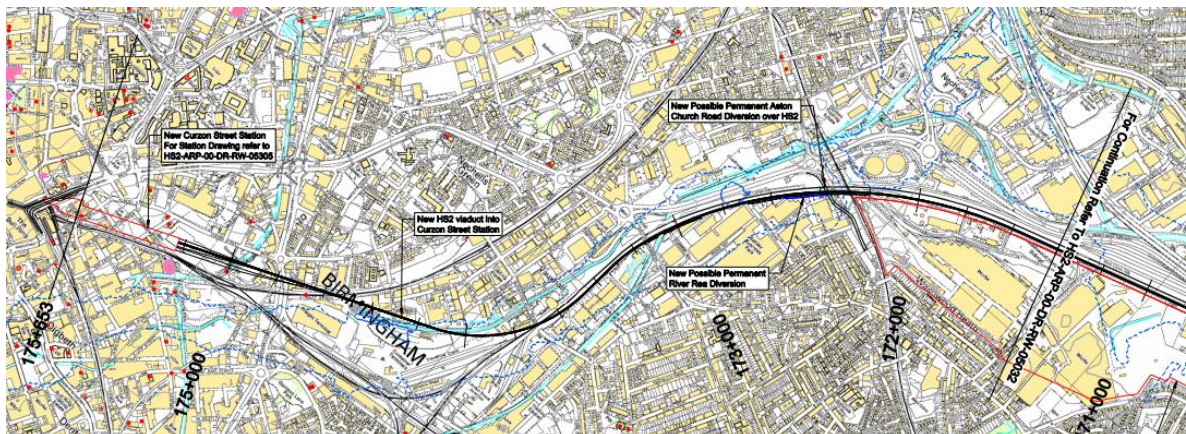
Planta do traçado do viaduto sobre o centro da cidade para acesso a “Curzon Street Station” (Unido, GOV.UK).
